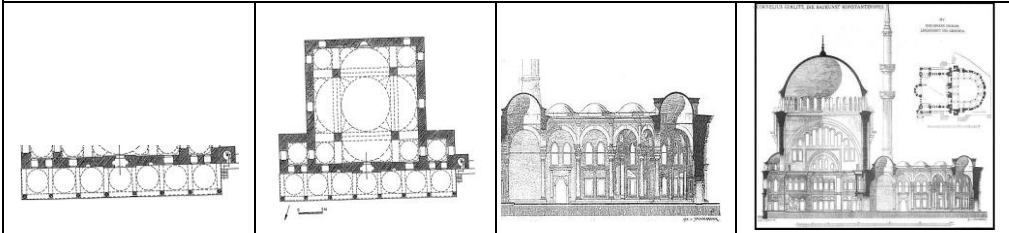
مسقط أفقي وقطاع ومنظور لجامع شهزادة باستانبول ضمن مجمعه يوضح الرواق الجانبي الذي يتقدم مخططه. (عن: كوران).
